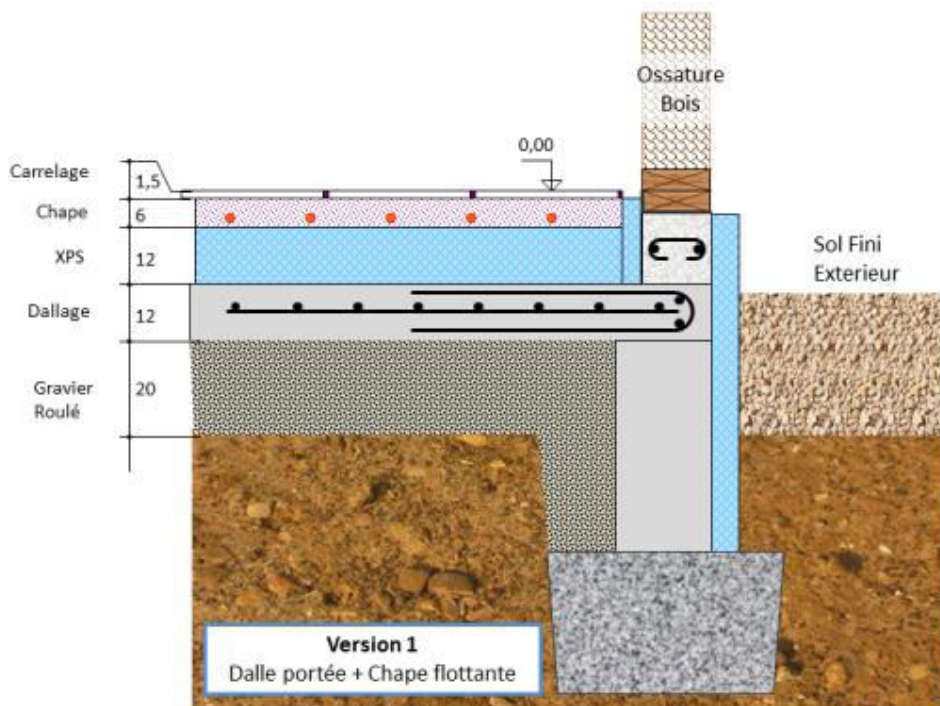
Schéma de dalle flottante sur terre-plein.
